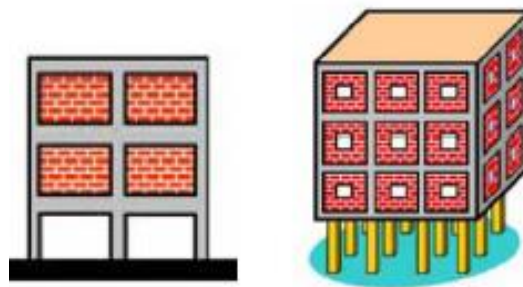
Modelo de Edificaciones con Planta Baja Libre
